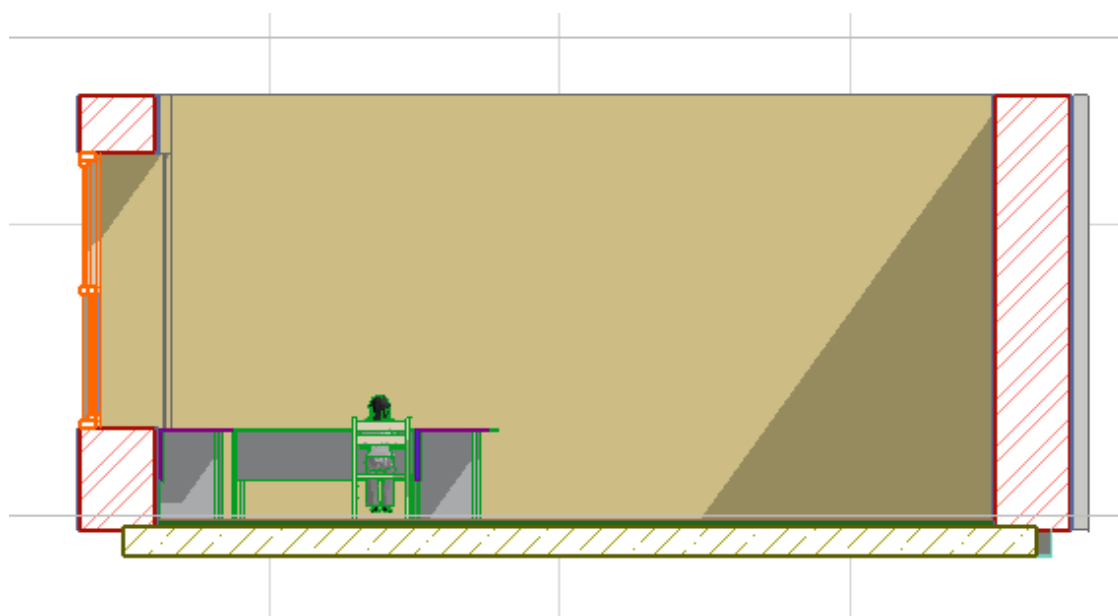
Поперечный разрез помещения с указанием рабочего места относительно оконных проемов
